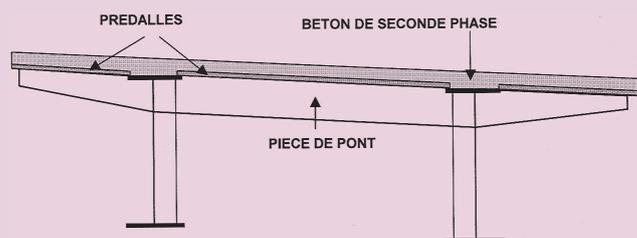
Bipoutre à pièces de pont coffré à l'aide de prédalles
